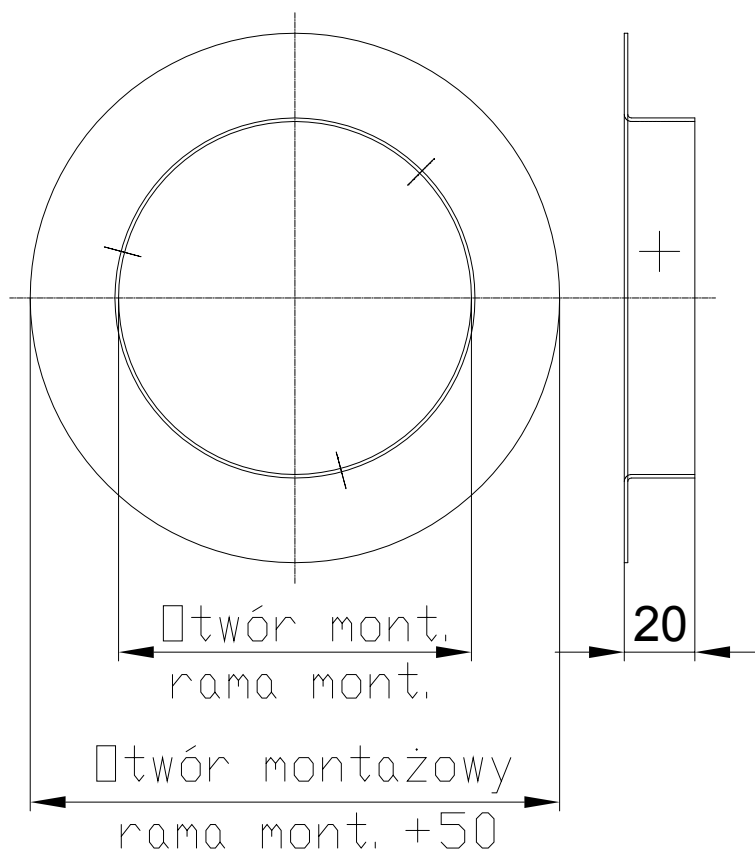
Sposób montażu klapy odcinającej typu BEK w przegrodach pionowych
